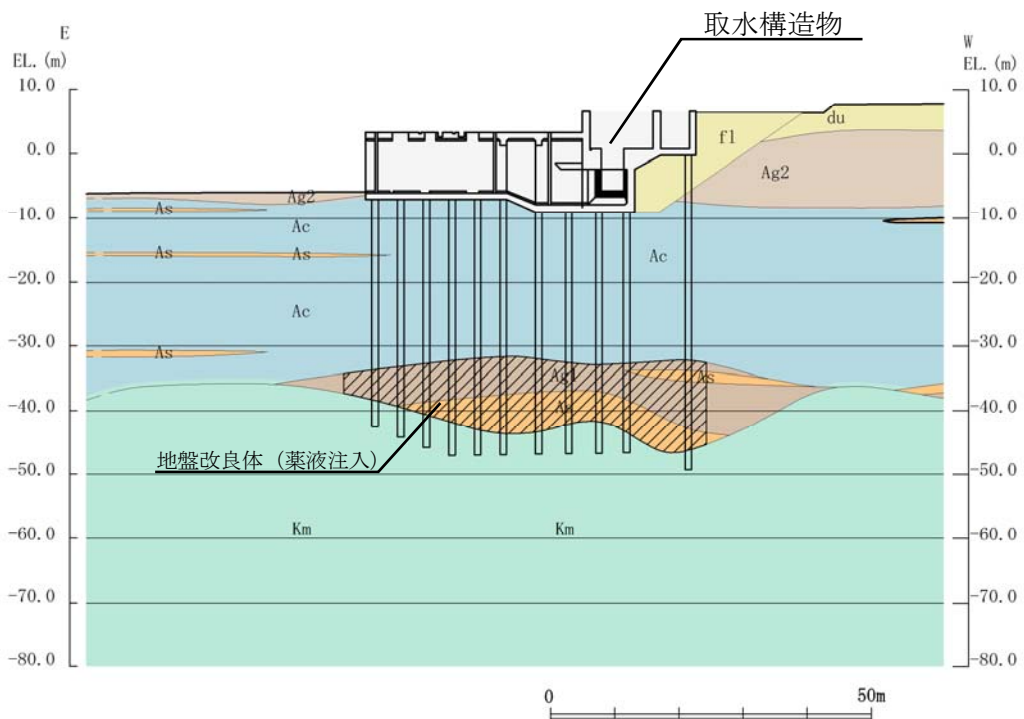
(3) 地質断面図 (⑥-⑥断面)
